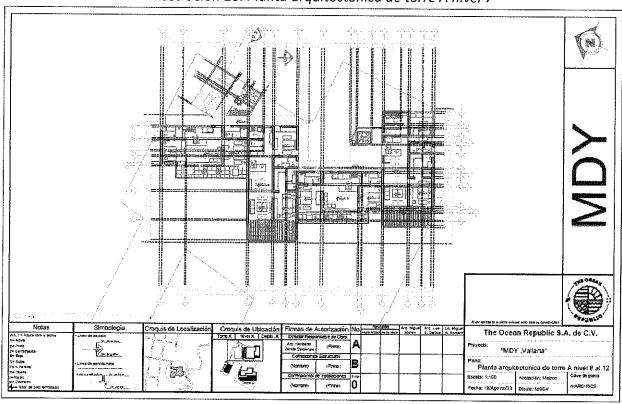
Planta arquitectónica de torre A nivel 8 al 12
